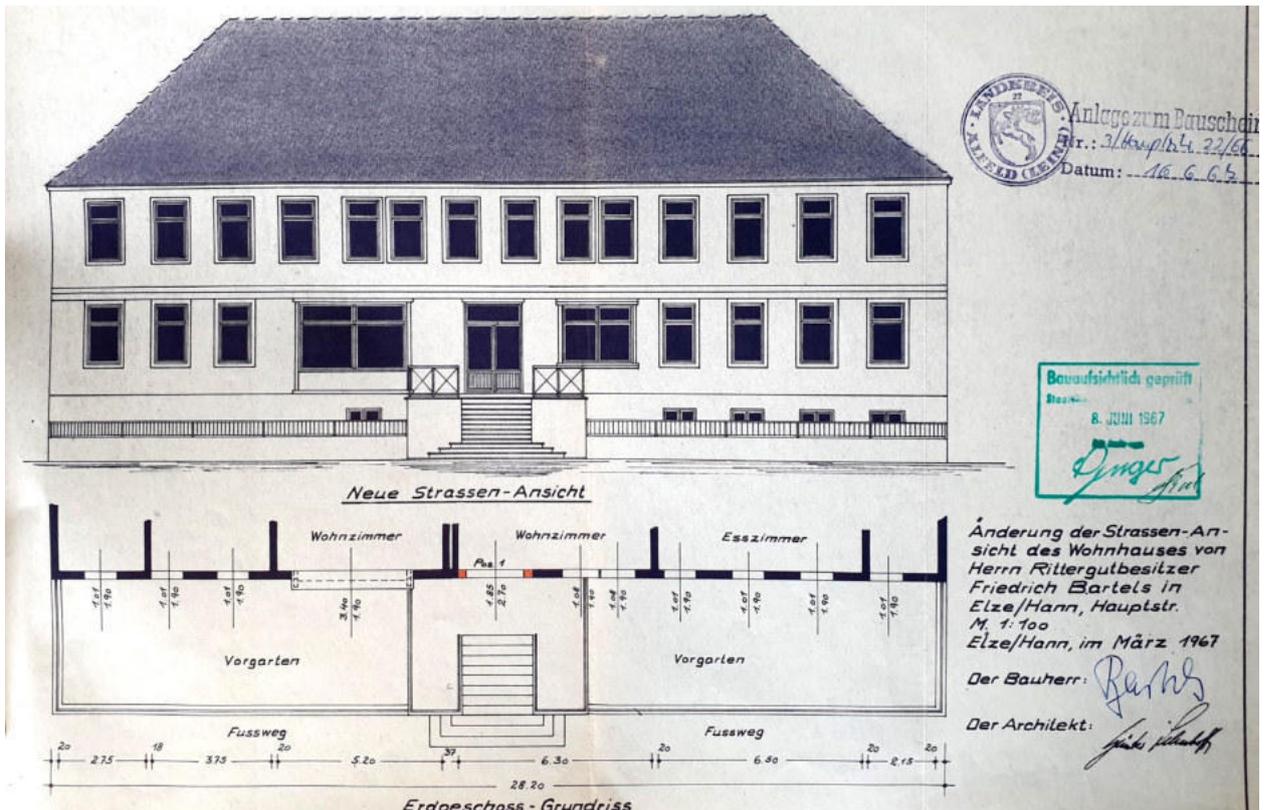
Fassadenansicht und Grundrissausschnitt mit Darstellung der Verbreiterung des Hauseingangs, 1967. Mit der Baumaßnahme wurde die wohl noch kernbauzeitliche Haustür durch eine moderne Zweiflügeltür ersetzt. Der Laubenvorbau ist inzwischen (seit 1959) beseitigt.
